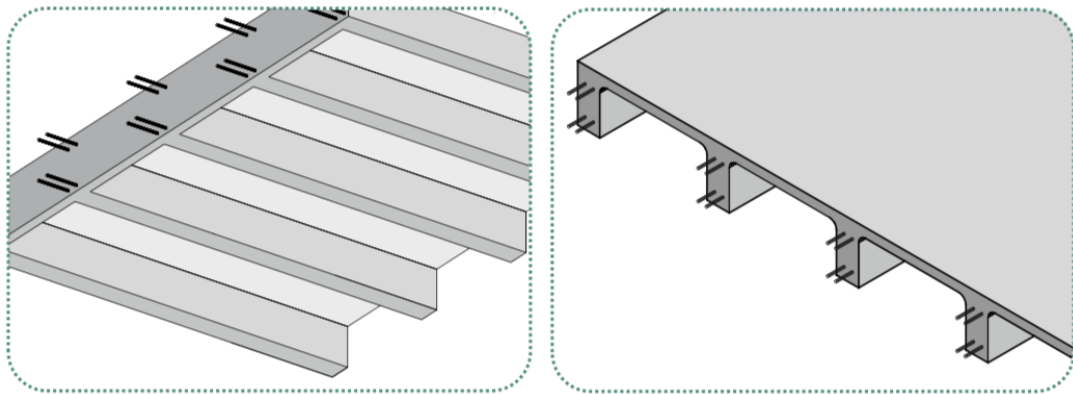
Detalle de vista inferior e superior de forjado unidireccional de hormigón armado in situ
